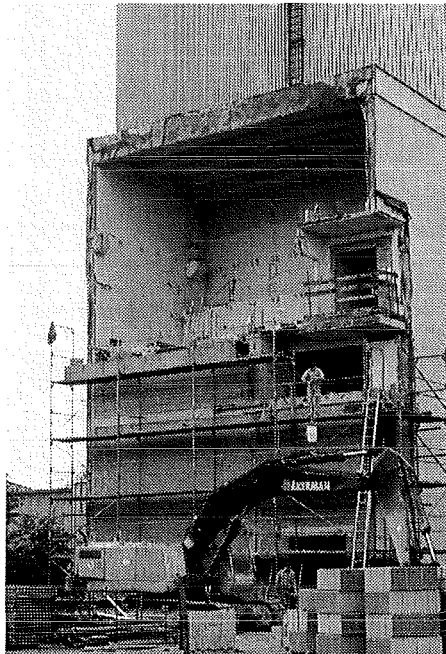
Verschluss der nördlichen Anschlußöffnung des Reaktorgebäudes nach Abriss des Lagerbeckengebäudes
